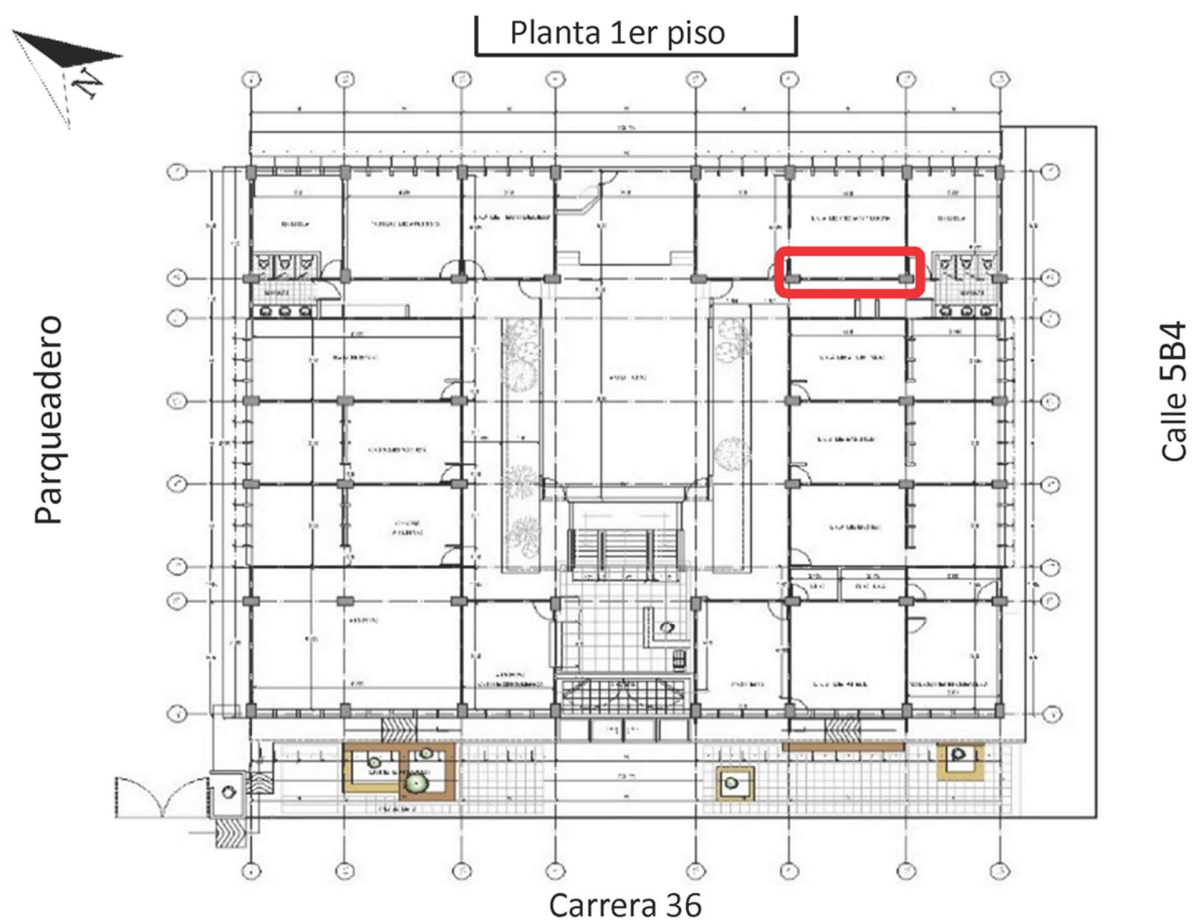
Localización de lesión Grieta en muro de mampostería no estructural (GM2).
